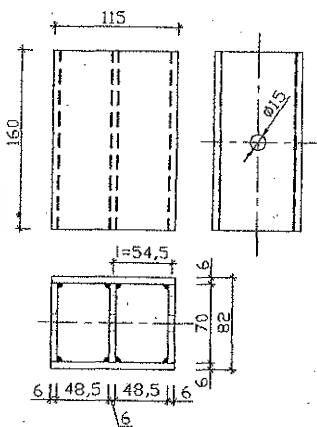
Сварной вкладыш конькового узла
